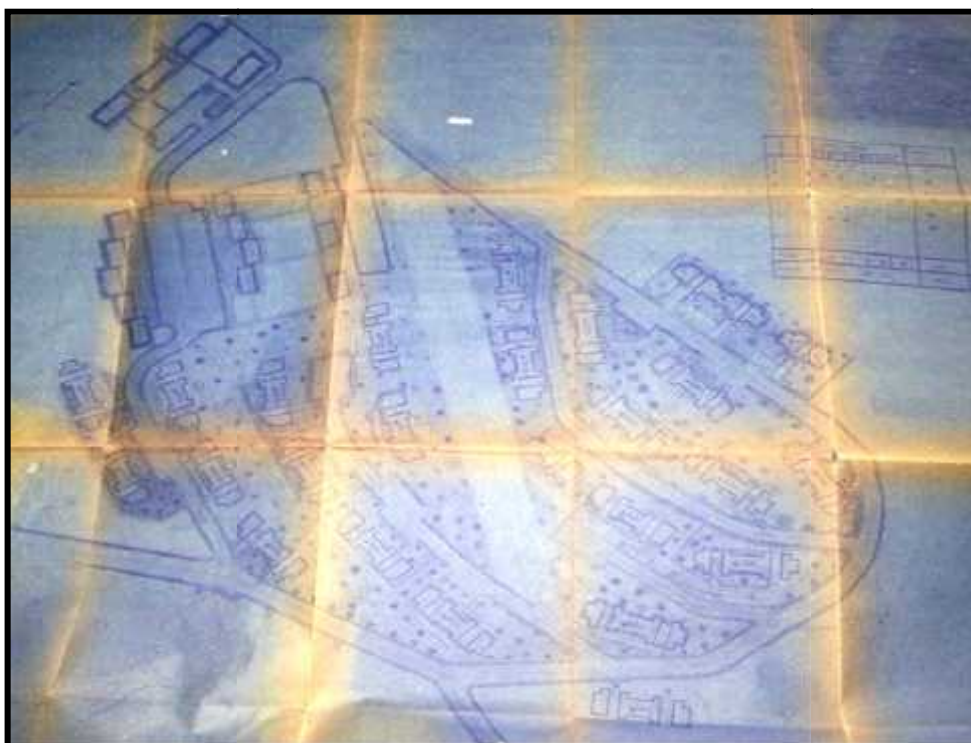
Plan de masse du 1er cas d'étude 418 logements (source: OPGI).
